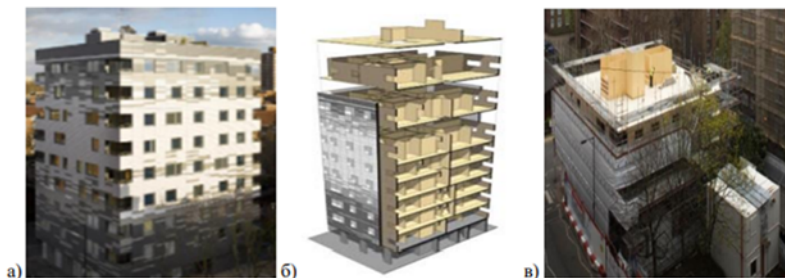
Многоэтажное жилое здание Stadthaus (г. Лондон, Великобритания): а) общий вид, б) конструктивная система; в) возведение лестнично-лифтового узла из CLT-панелей
